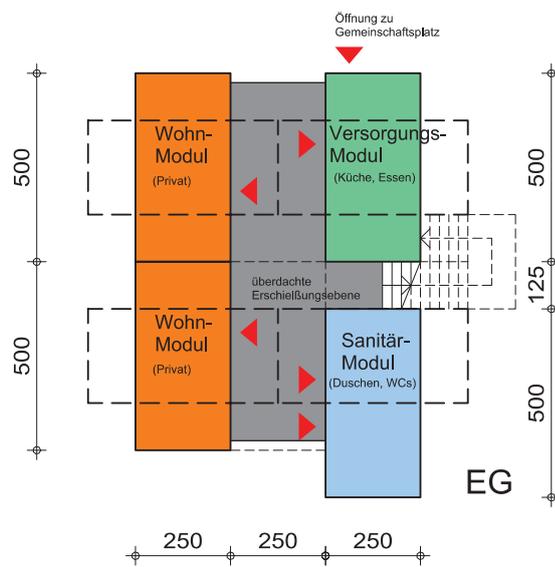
Grundrisse - Wohn-Container-Gruppierung
